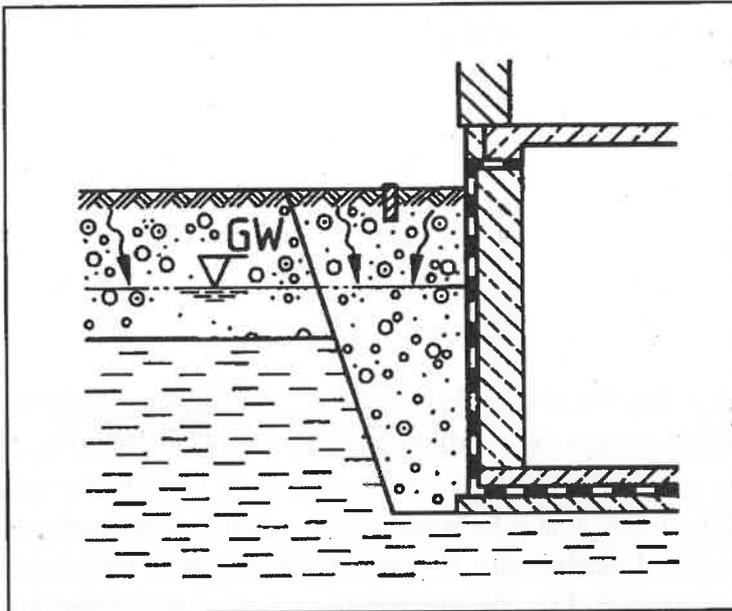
Kellerabdichtung nach DIN 18195 T 6
